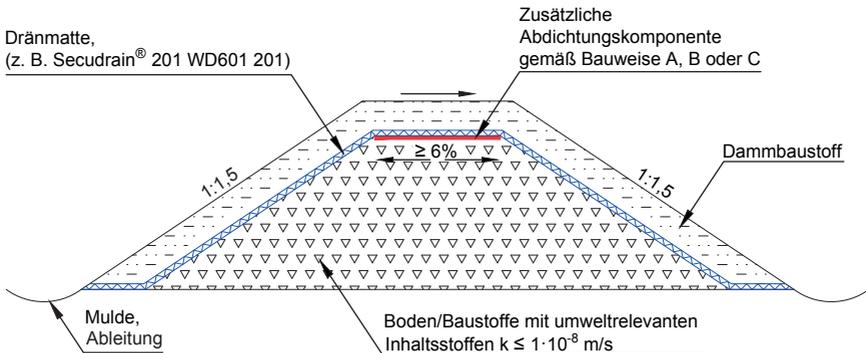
Ausführungsvorschlag für einen Wall in Bauweise E (Variante 2) mit Geokunststoffen
